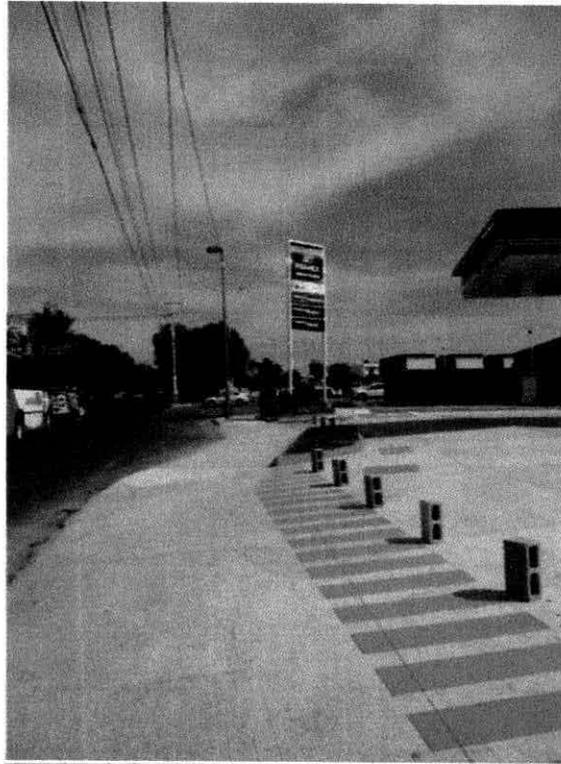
Vista de la colindancia Norte.
